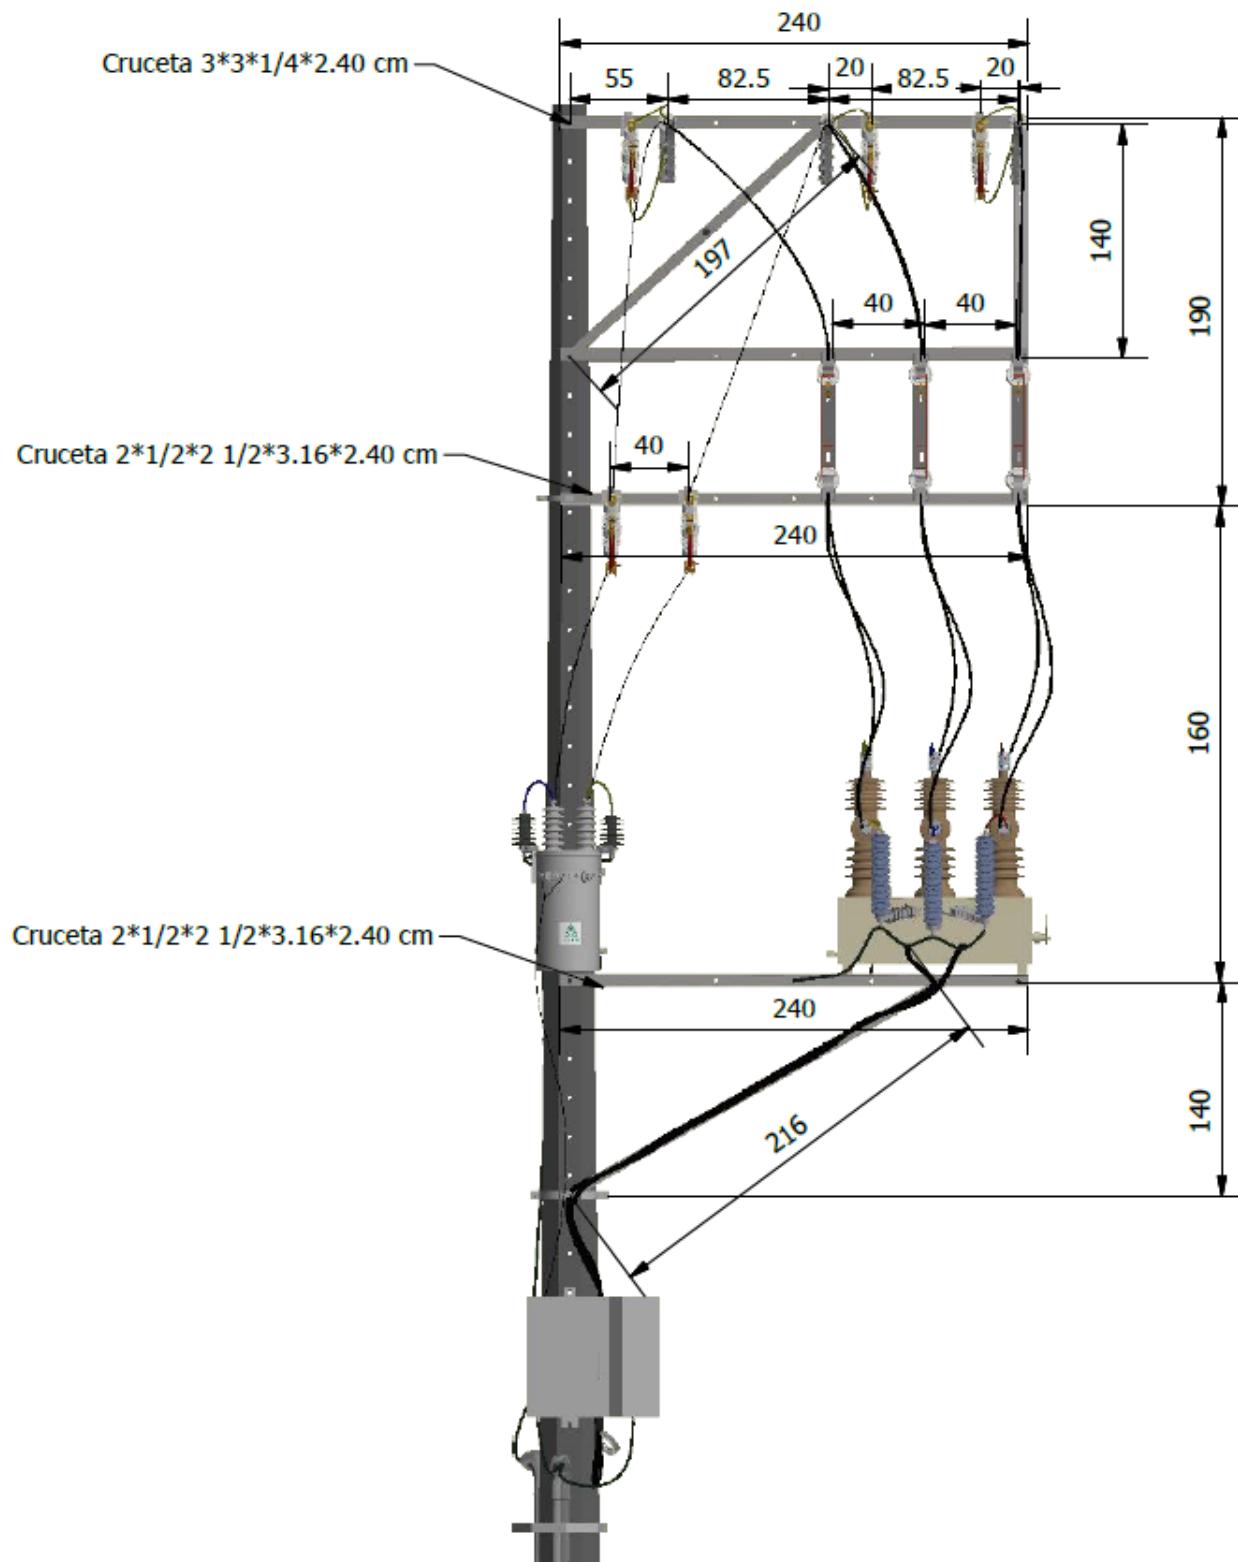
Dimensiones del montaje reconnectionador 13.2kV
